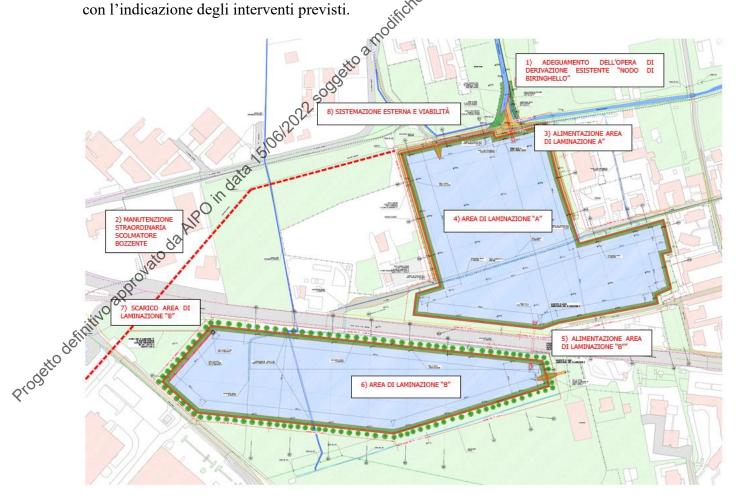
estratto planimetrico degli interventi in progetto: keymap
